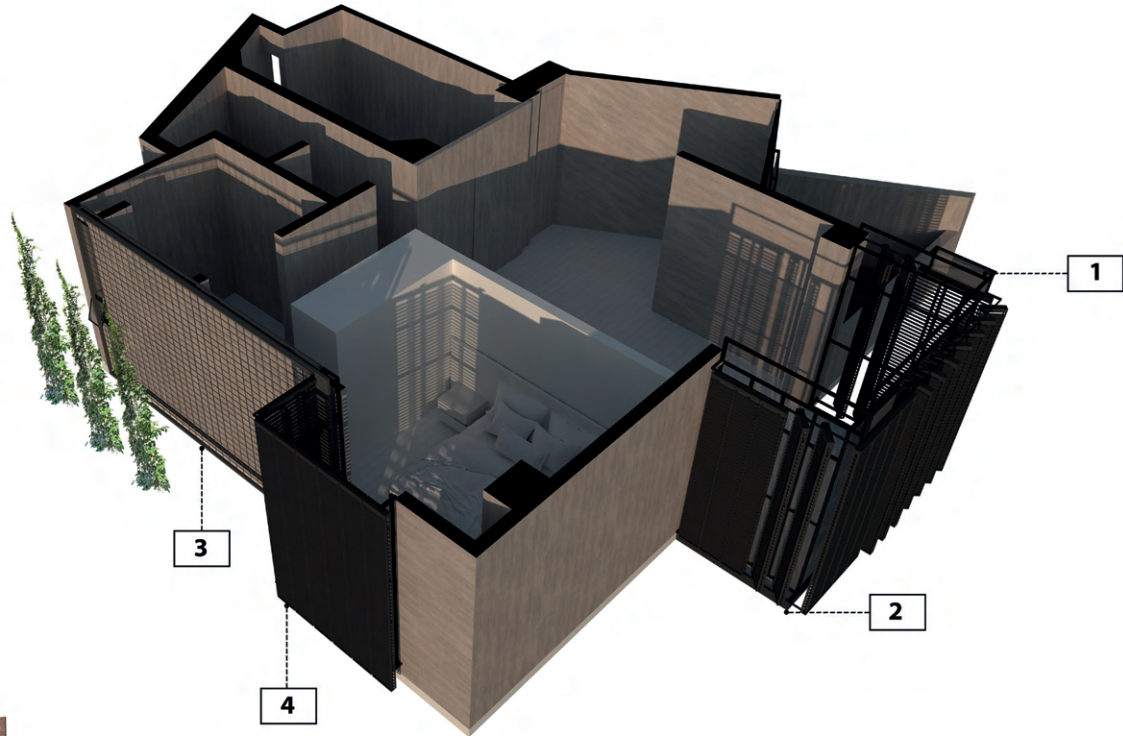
Axonometría con intervención del sistema de fachada – Edificio O'Byrne
